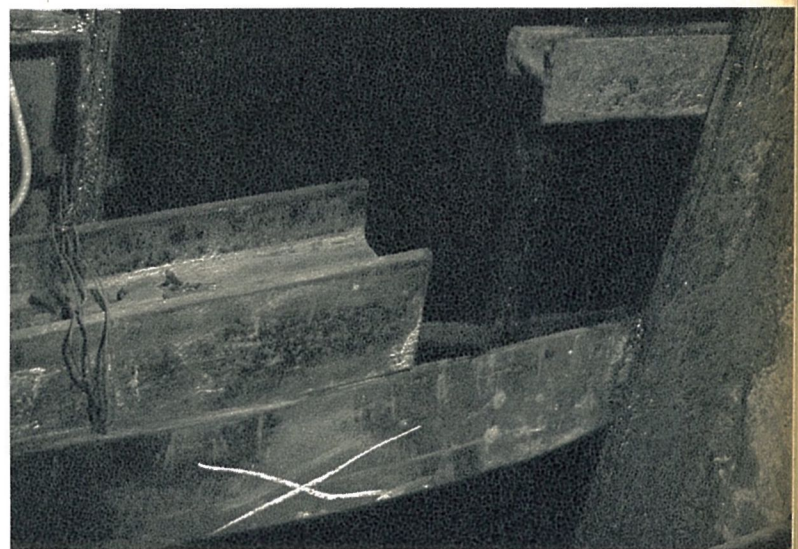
poutrelle de 12 cm de h. de calage des « liner-plates » complètement écrasée sous la poussée des terres.
